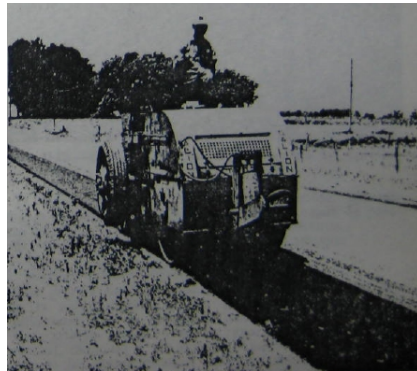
Extendiendo el material asfáltico mezclado en planta en caliente sobre un borde asentado
